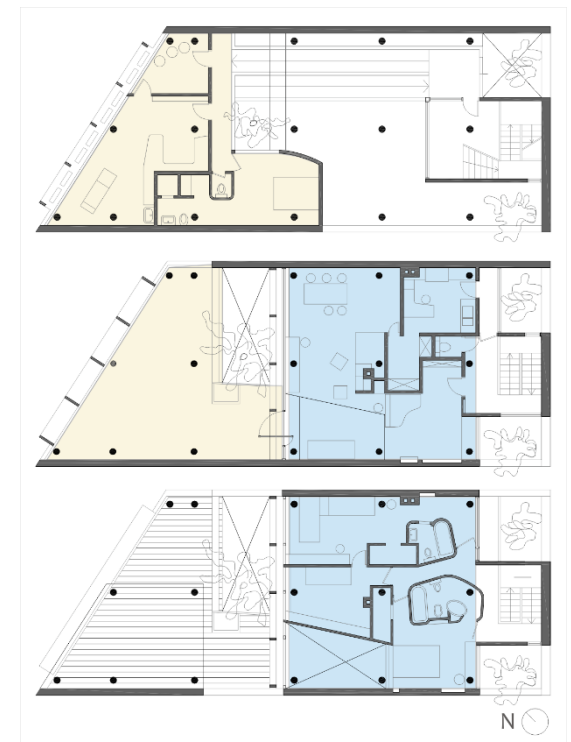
Casa Curutchet. Planta baixa do primeiro e segundo pavimento, respectivamente. Em amarelo a porção que origina a clínica e o terraço, em azul a residência. Fonte: Autora, 2016.
